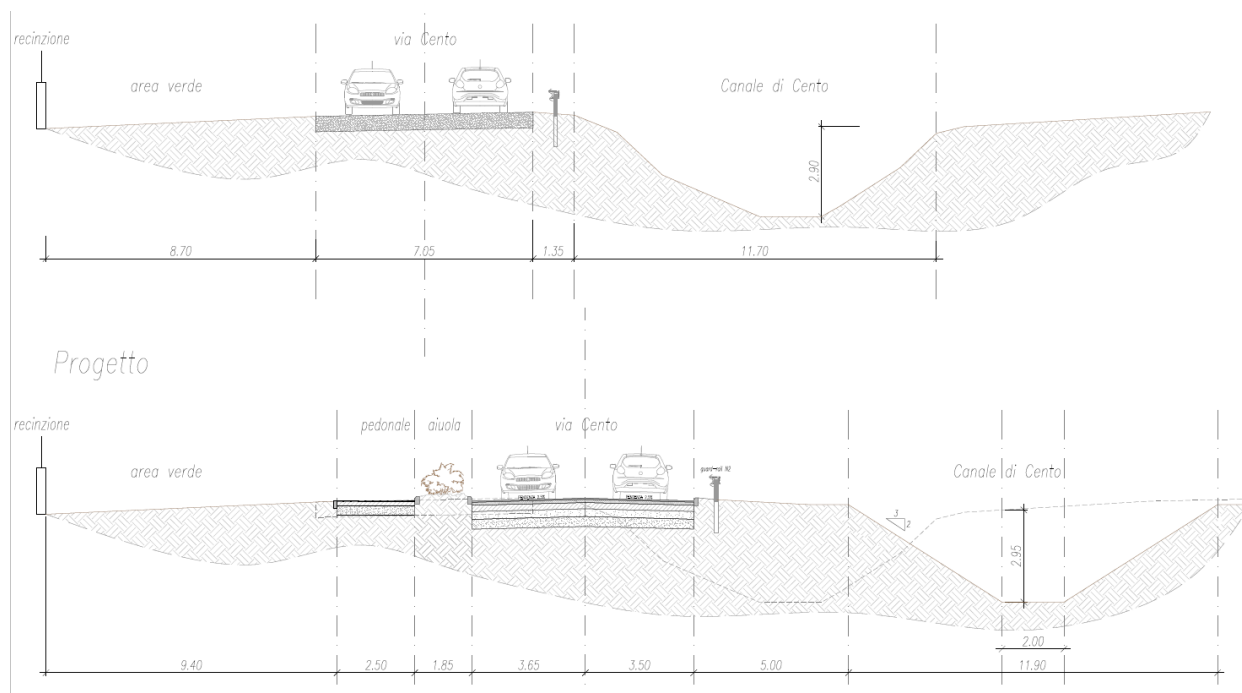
Sezione tipo stato di fatto e progetto in Via Cento
